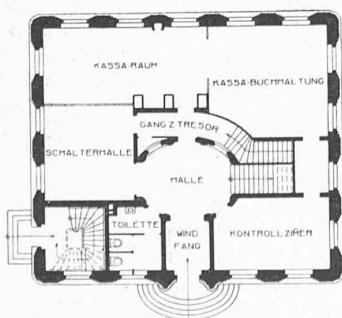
Erdgeschoss. — Masstab 1 : 400. —
